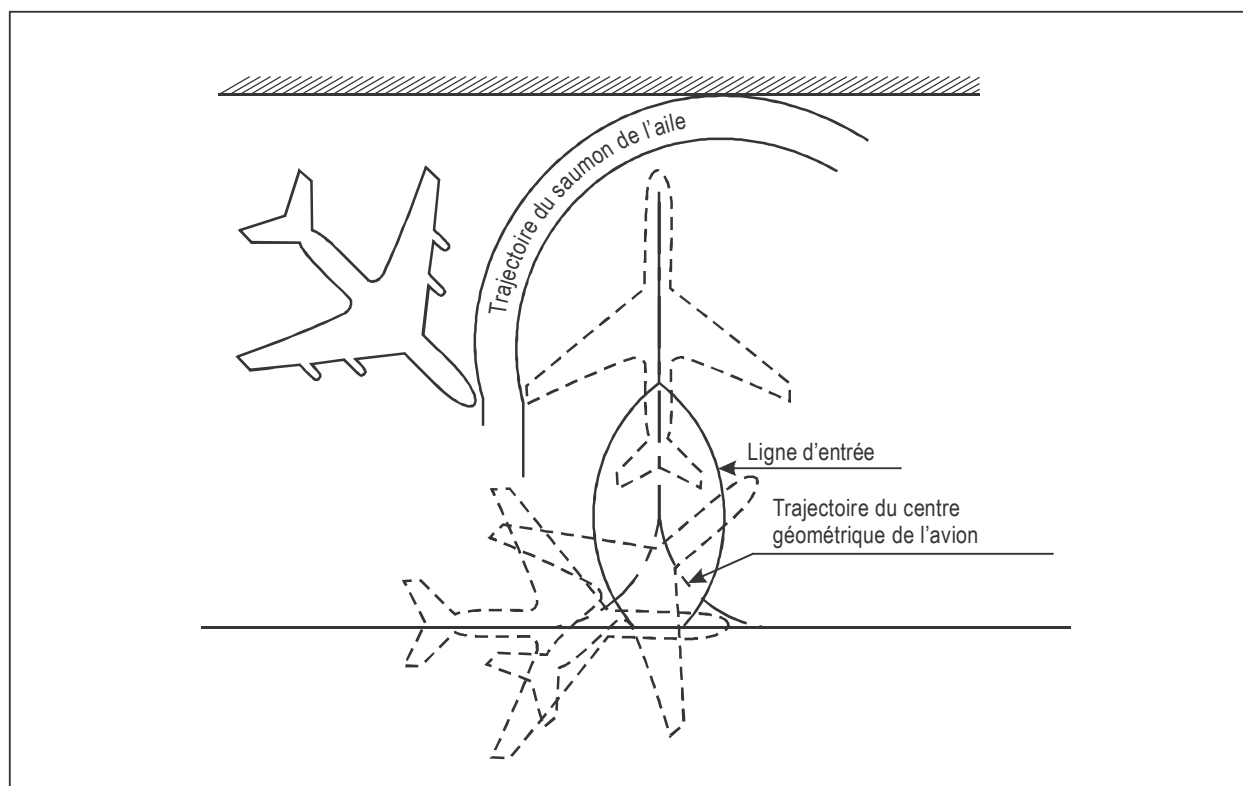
Ligne d'entrée décalée pour le guidage de la roue avant
